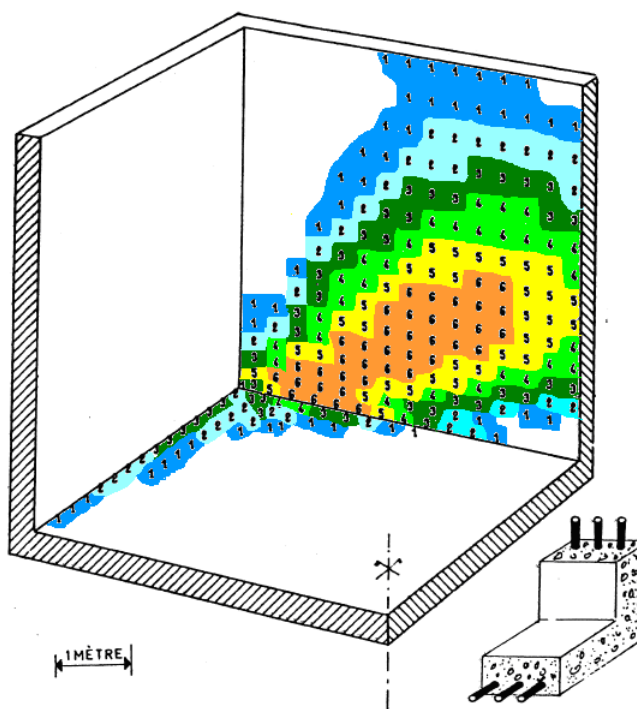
Cuve carrée en béton armé. Carte de ferrailage des aciers Y extérieurs (en cm² par mètre).
